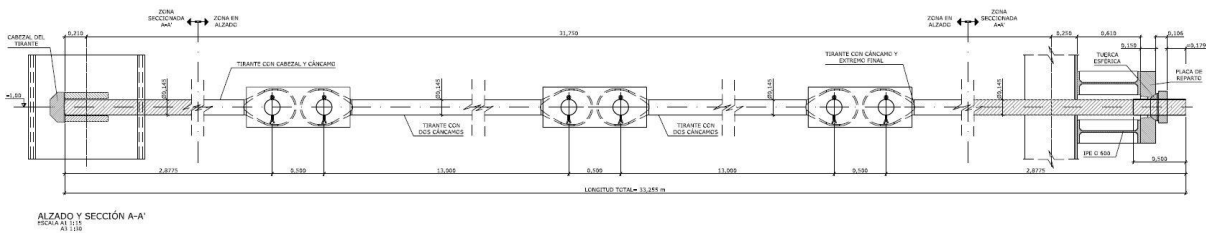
Alzado de los tirantes de la Sección tipo 1
